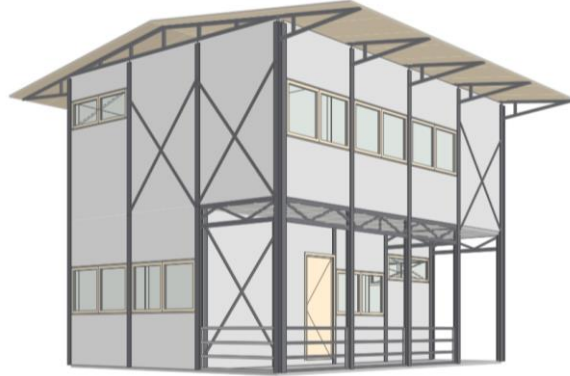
Vivienda de 2 plantas (Opción A)
